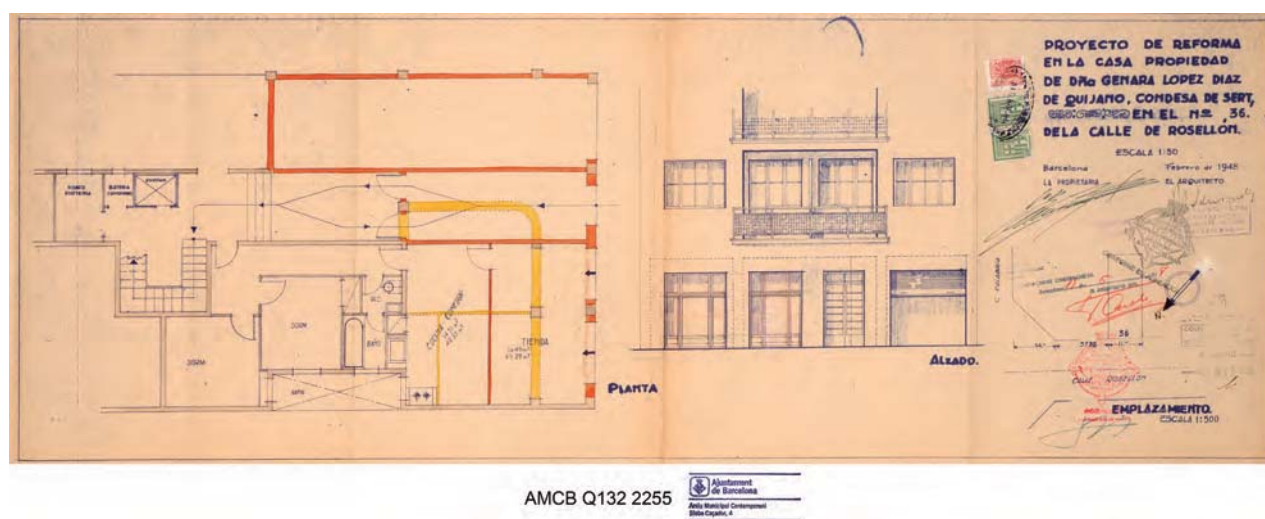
Reforma planta baja de las viviendas de Rosselló, 1948-1952.
